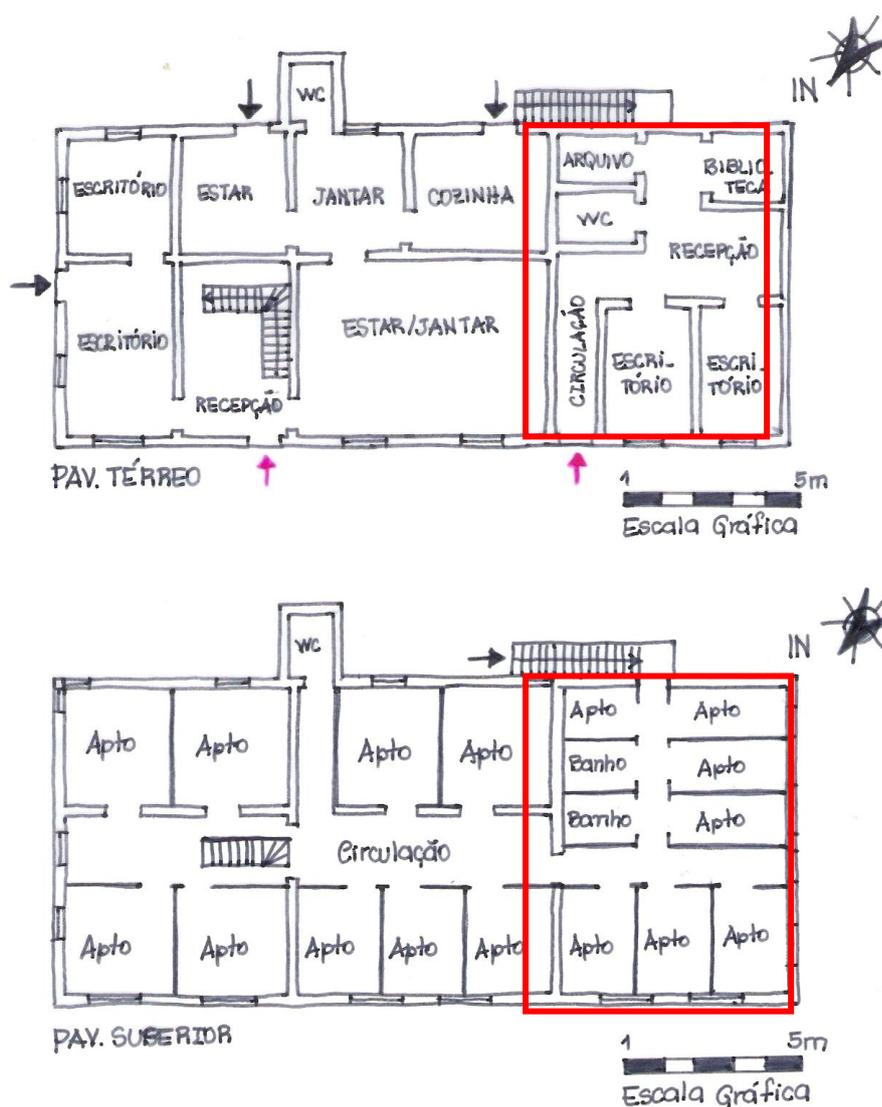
Plantas baixas esquemáticas da edificação, em 2011.
